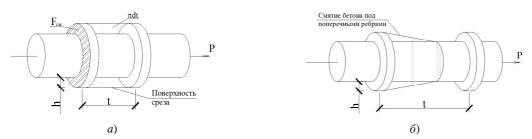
Механизм разрушения бетона у ребер арматуры: a – срез бетонных шпонок (t / h < 10);  $\delta$  – смятие бетона под ребрами арматуры (t / h > 10)
